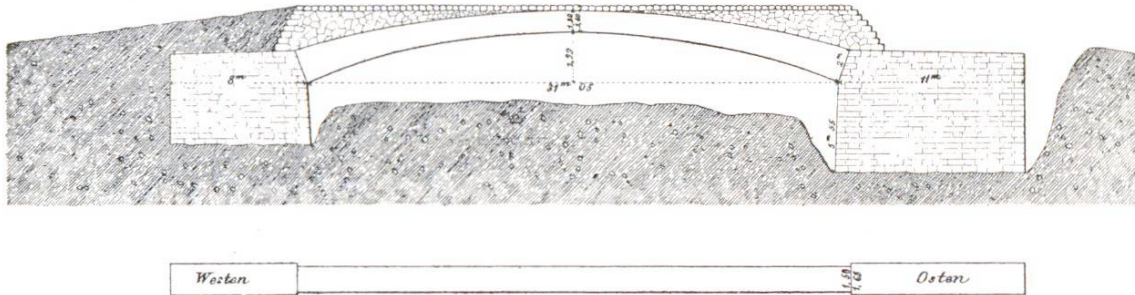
Ansicht und Grundriss des Bogens vor den Versuchen
